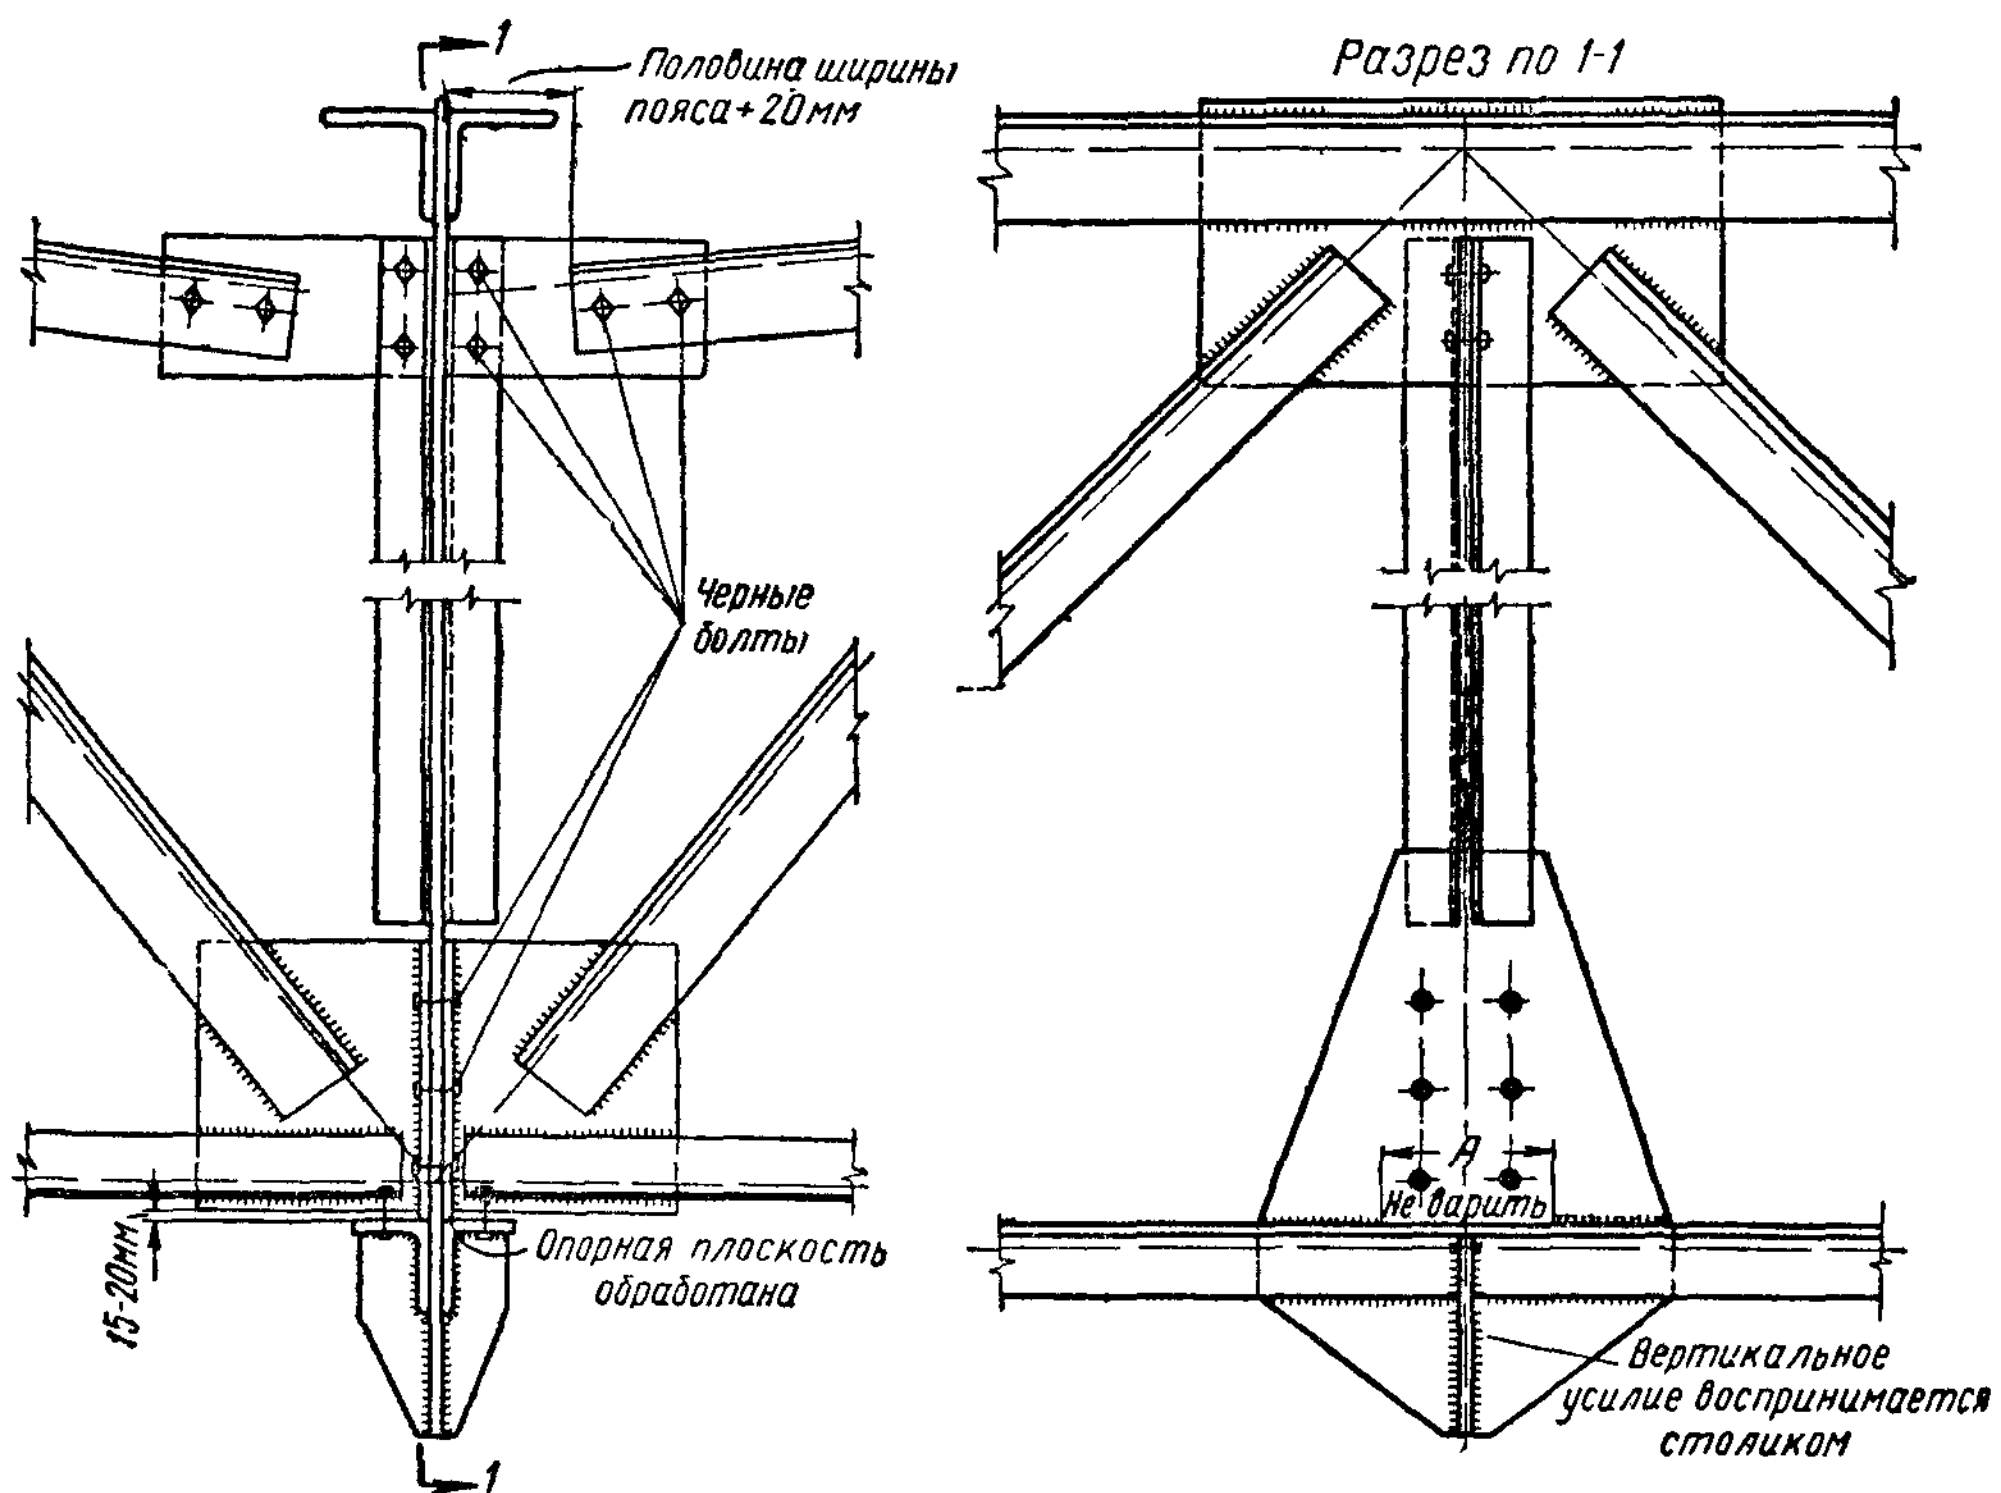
Прикрепление стропильных ферм к подстропильной с передачей вертикального давления на столик
